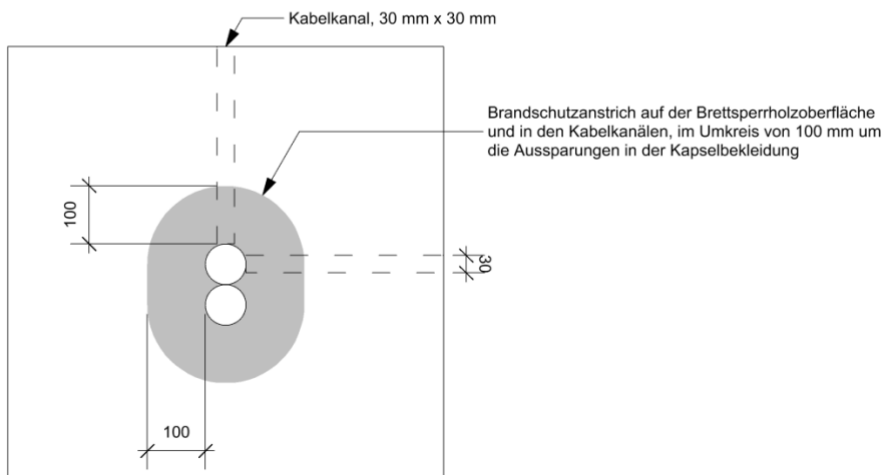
Schutz des Holzes im Bereich von Aussparungen in der Kapselbekleidung durch Brandschutzanstrich auf der Holzoberfläche, Maße in mm
